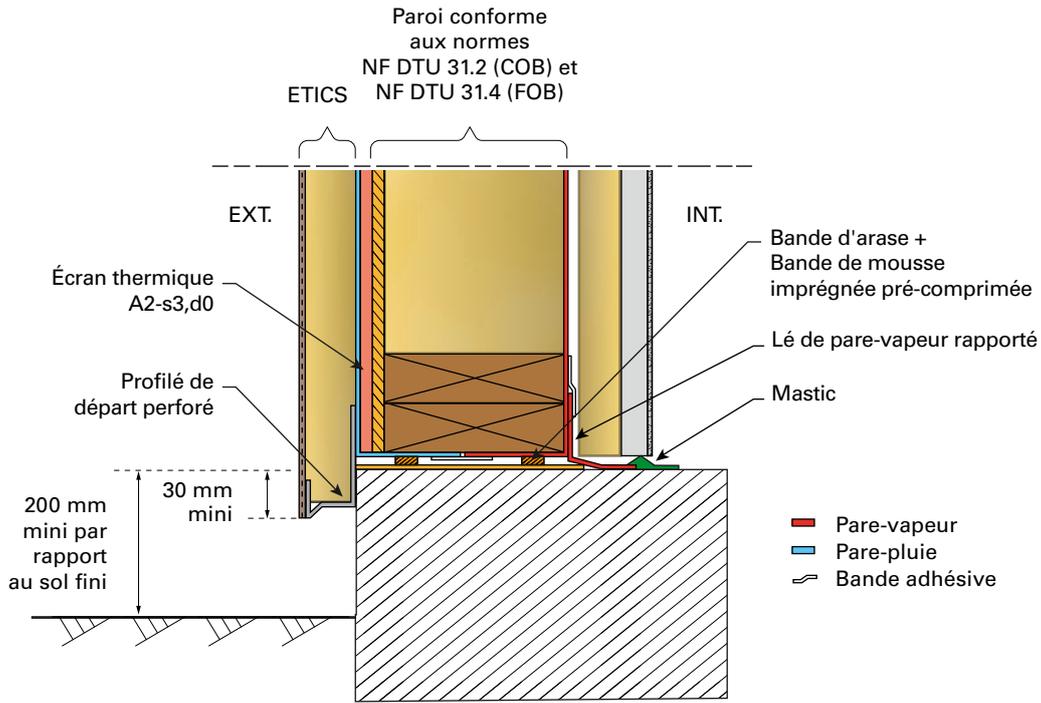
Exemple de pied de façade avec un pare-pluie souple
